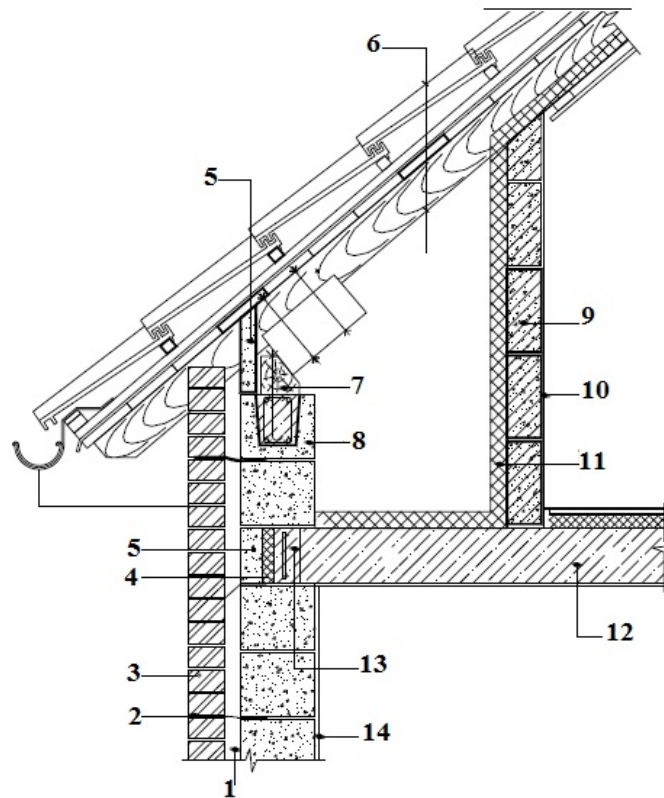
Сопряжение несущей стены из газобетона с мансардным этажом и монолитным перекрытием: 1 — воздушный зазор; 2 — гибкие связи; 3 — облицовочный кирпич; 4 — минеральная вата или пенополистирол; 5 — доборный блок; 6 — кровельная конструкция; 7 — мауэрлат; 8 — U-образные блоки; 9 — блоки YTONG; 10 — внутренняя штукатурка; 11 — минеральная вата; 12 — железобетонная плита; 13 — монолитный армированный пояс; 14 — внутренняя отделка
